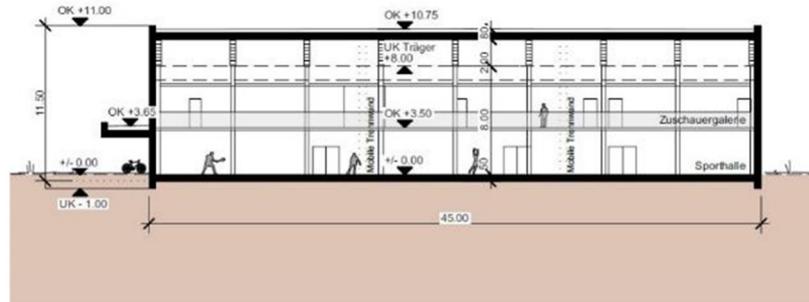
„aufgesetzte“ Doppelsporthalle B | Disposition 2 - Längsschnitt
